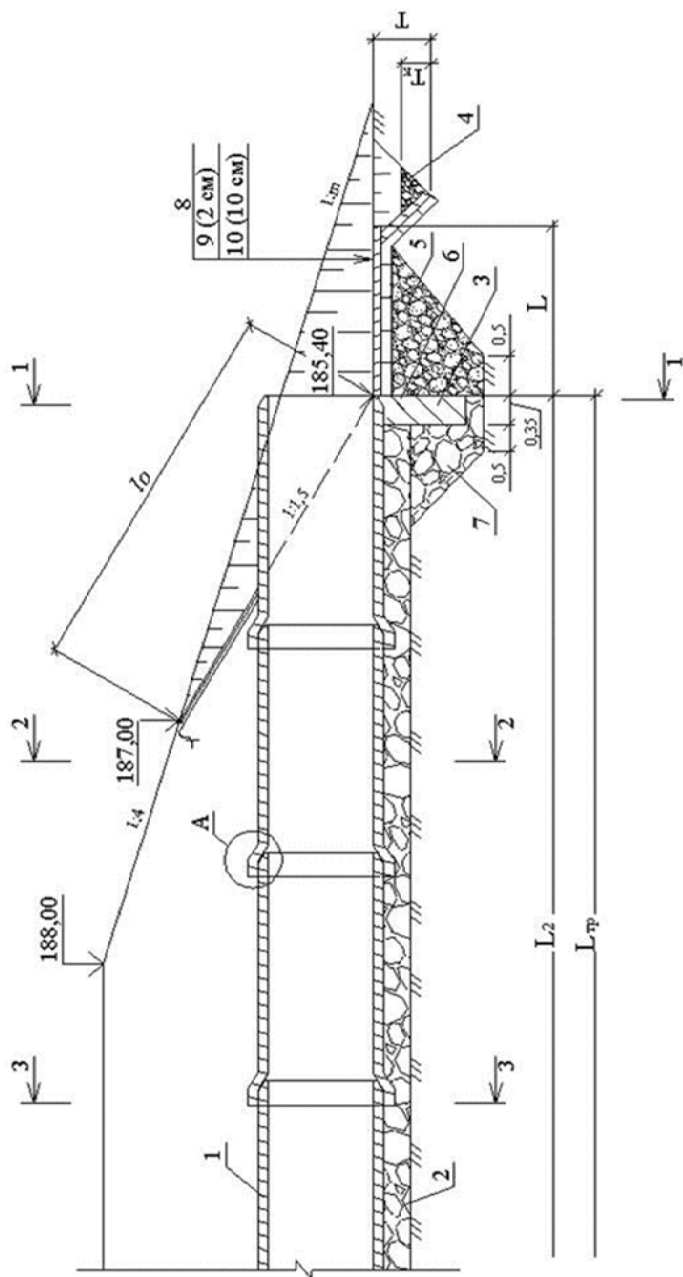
Продольный разрез безфундаментной трубы на выходе при заложении откоса насыпи 1 : 4:
